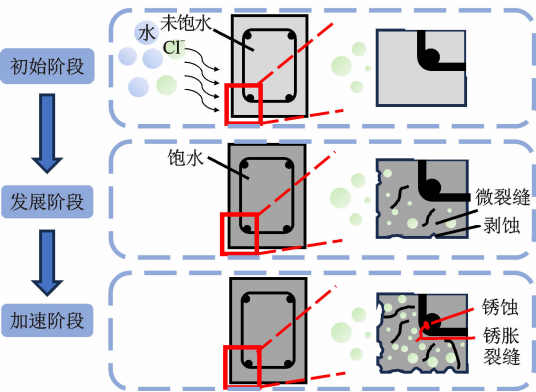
混凝土桥梁中混凝土及钢筋性能劣化演变
